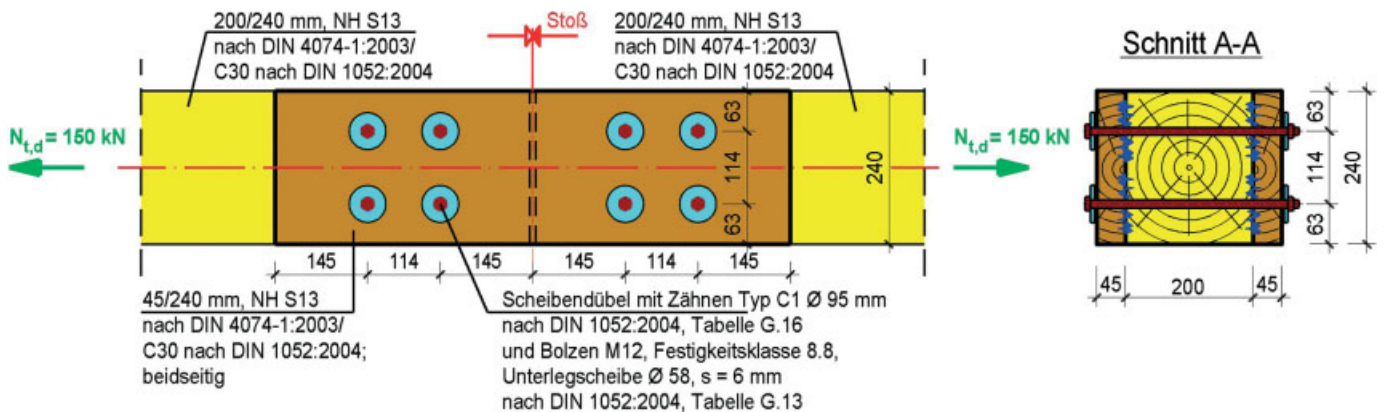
Konstruktion des Zugstoßes mit Laschen aus Nadelholz S13 nach DIN 4074-1 und Dübel besonderer Bauart Typ C1
